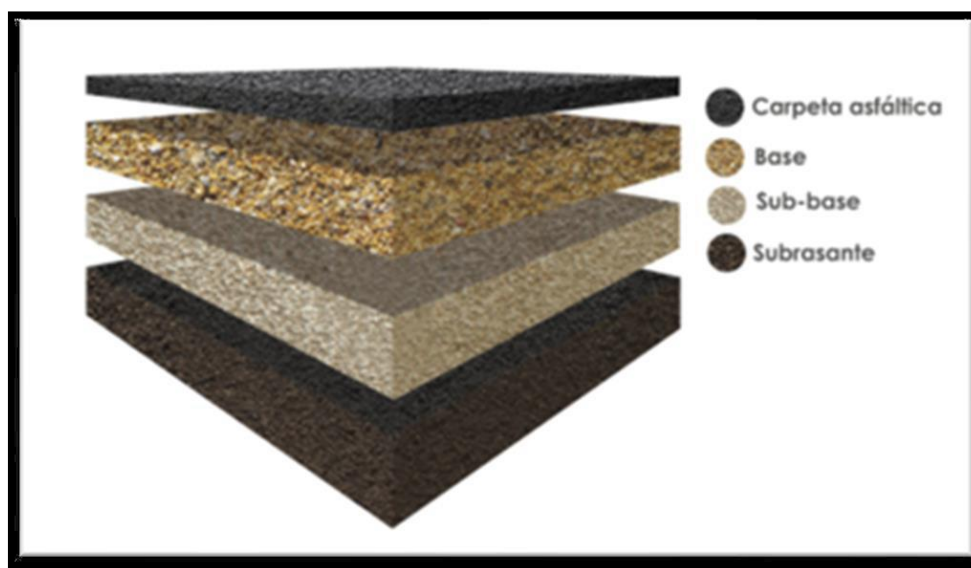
Fuente Loría Guillermo, Tipos de Pavimentos, Pavimentos
